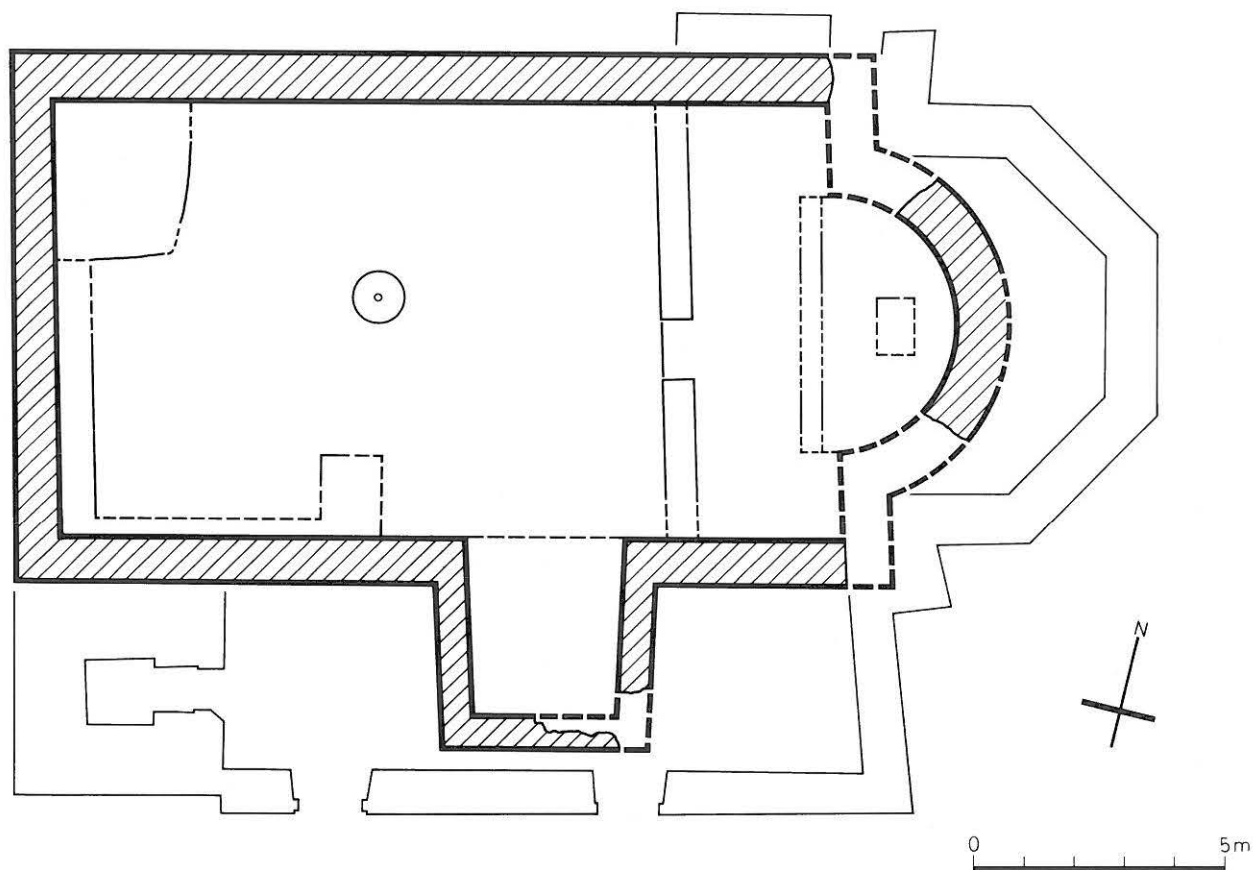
Rekonstruktion des Grundrisses der Kirche IV. M. 1:150.
